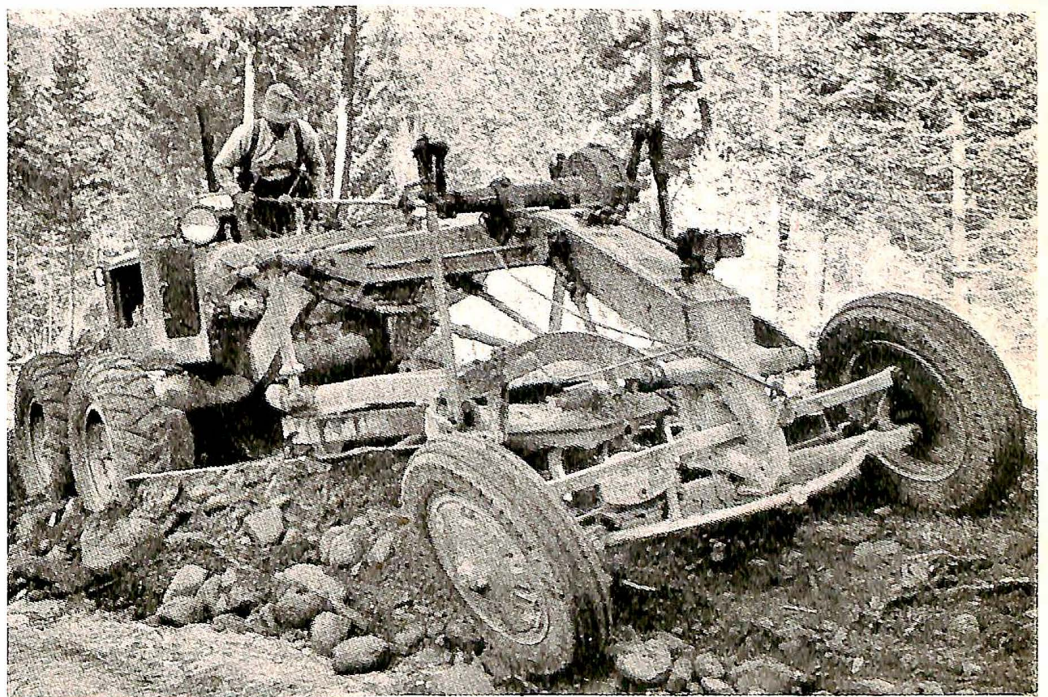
Motor grader med motor-mekanisk manøvrering og oppriver.
